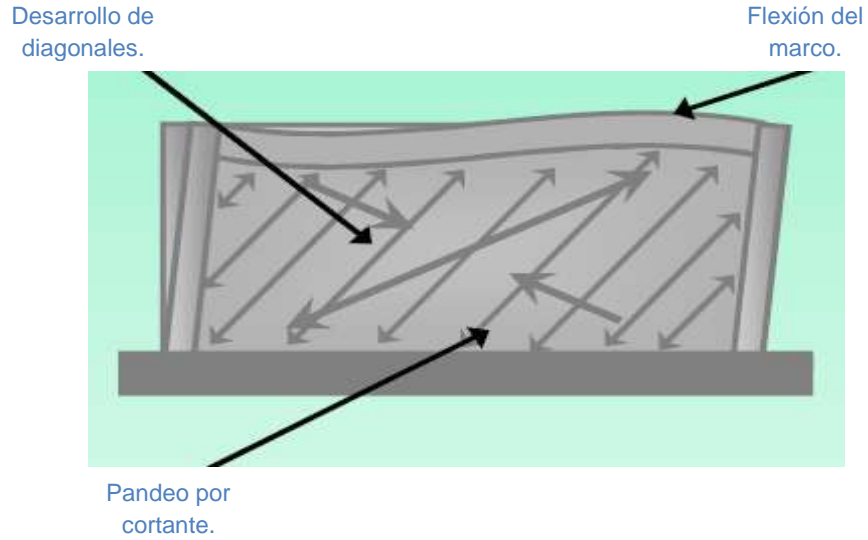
a Comportamiento estructural del muro de corte de placas de acero.
